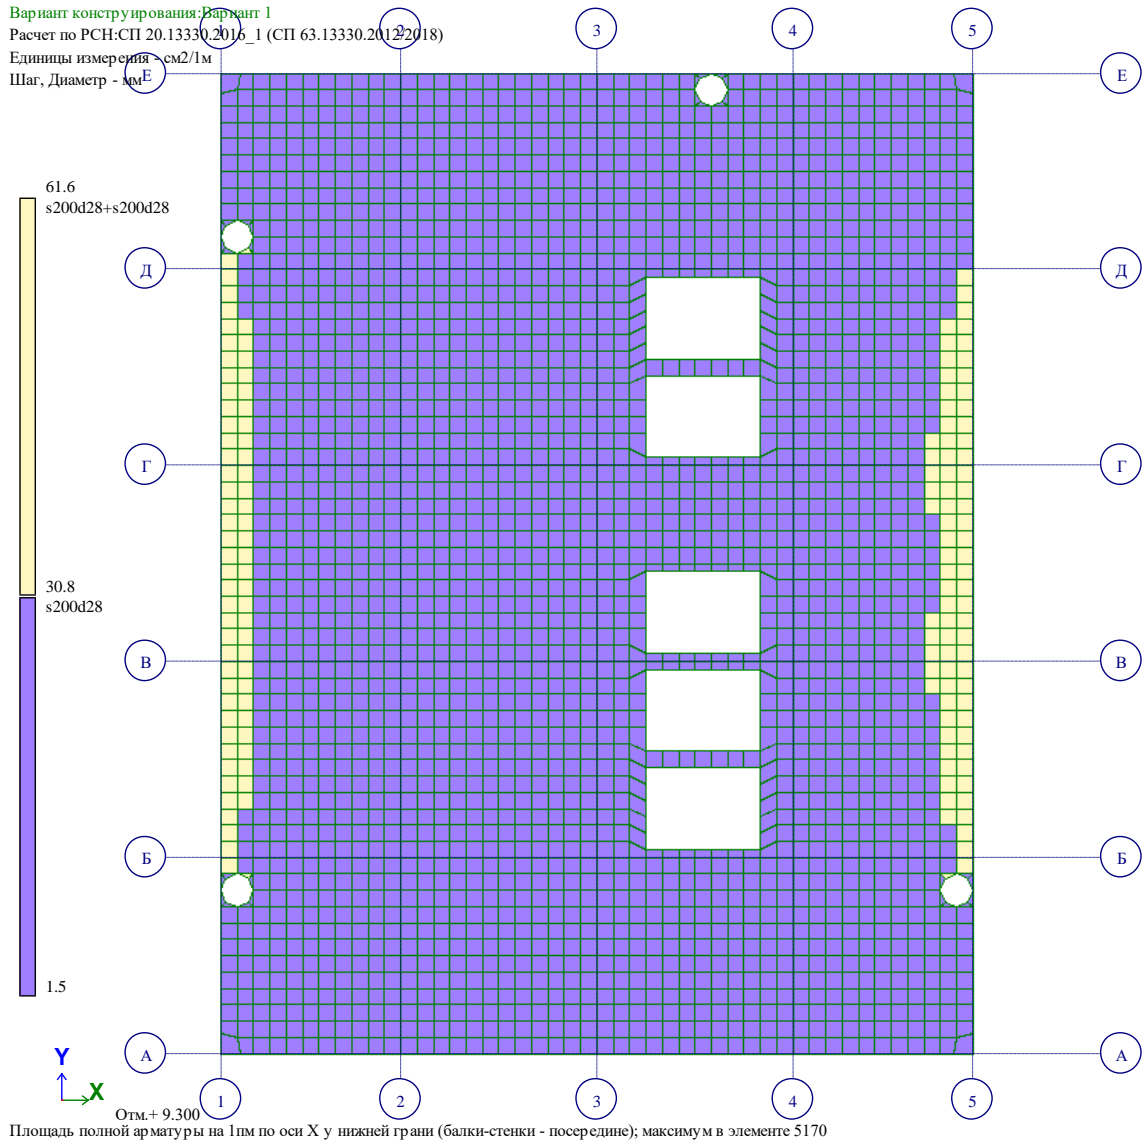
Изополя армирования (плиты перекрытия на отм. +0,000) - нижняя арматура по X
